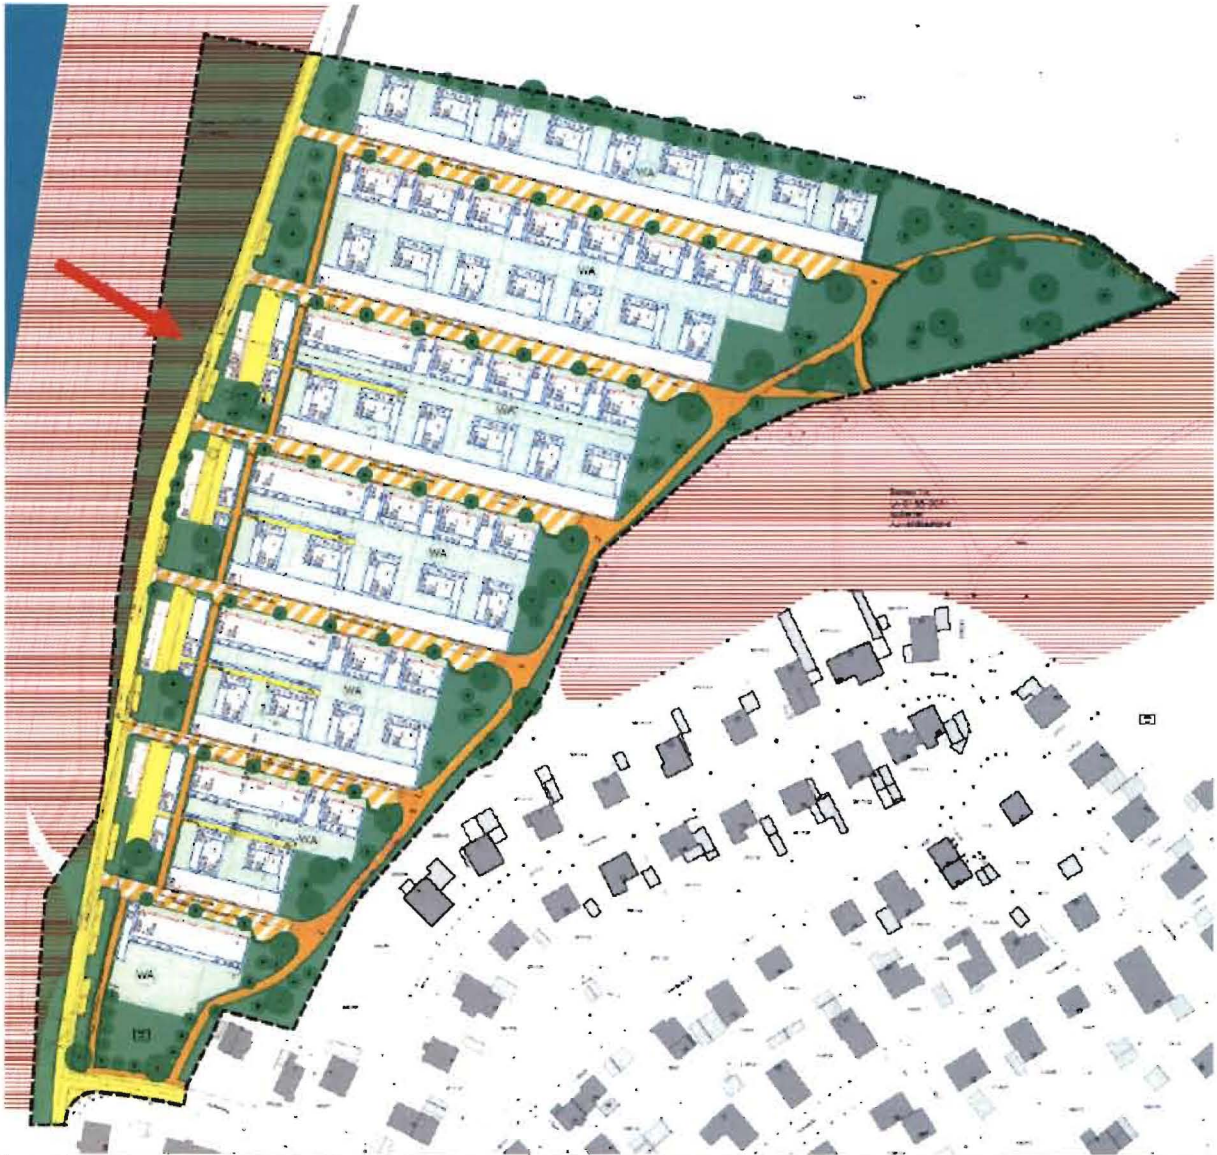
(Bebauungsplan Nr. 06-16b „Schönbrunner Wasen“; Untere Auenstraße – Verlängerung B; Pfeil rot)
